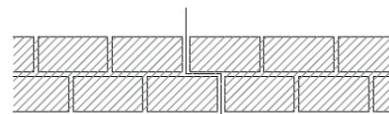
Junta de movimiento con solape. Esquema en planta
